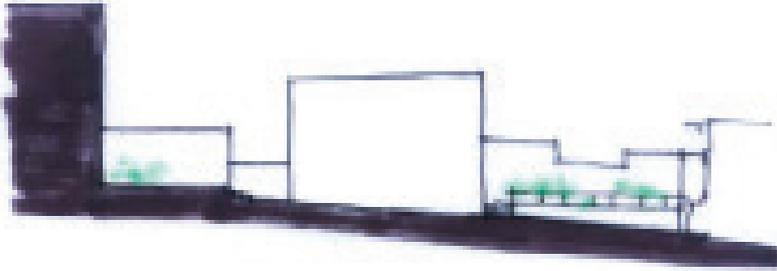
Corte esquemático longitudinal da praça Vila Canoas
